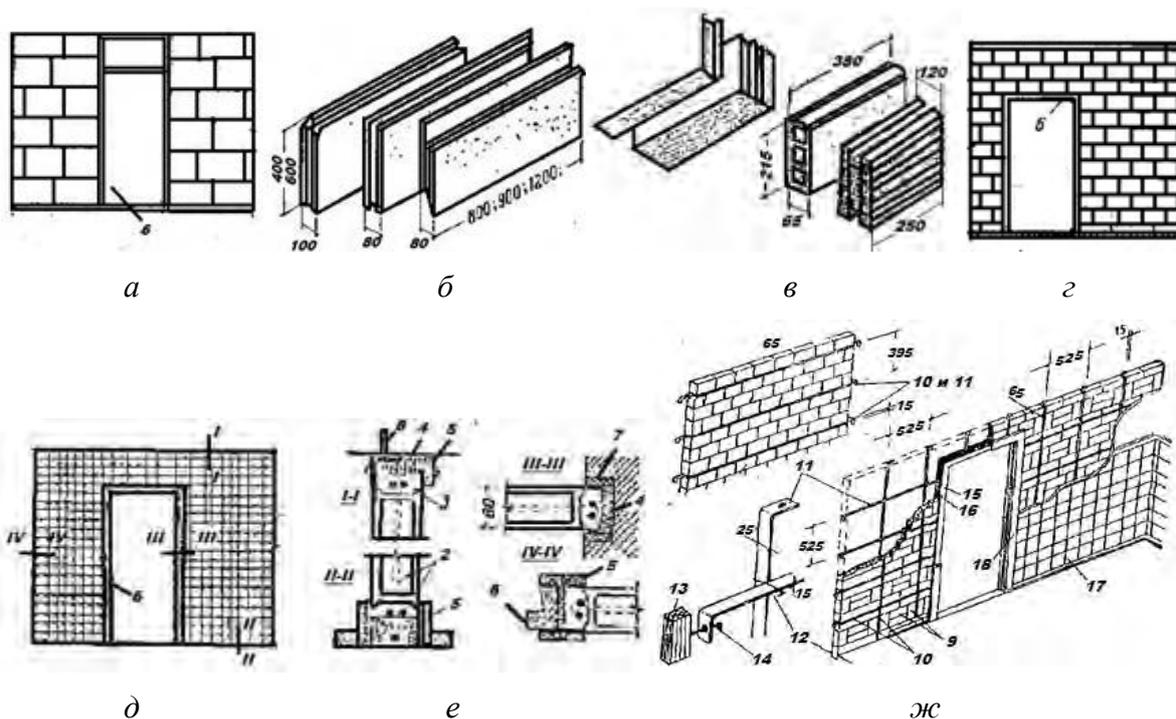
Мелкосборные, стекложелезобетонные и облегченные кирпичные перегородки: *a* — перегородка из гипсовых или пенобетонных плит; *б* — гипсовые плиты, армированные рейками, камышом и т. п.; *в* — пустотелые гипсовые камни (продольная половинка и дельный); *г* — варианты пустотелых керамических камней; *д* — перегородка из пустотелых гипсовых плит; *е* — стекложелезобетонная перегородка: 1 — стеклоблоки; 2 — арматура диаметром 4 мм; 3 — цементный раствор; 4 — конопатка; 5, 13 — деревянные раскладки; 6 — дверная коробка; 7 — упругие прокладки или расшивка; 8 — анкер; 9 — обычный или облегченный кирпич «на ребро»; 10 — уширенный армированный шов; 11 — полосовая сталь 1,5 × 2,5 мм или пачечное железо; 12 — проволоочная скрутка; 14 — костыль или дюбель; 15 — дверная коробка; 16 — толь или толь-кожа; 17 — облицовка перегородки; 18 — наличник
